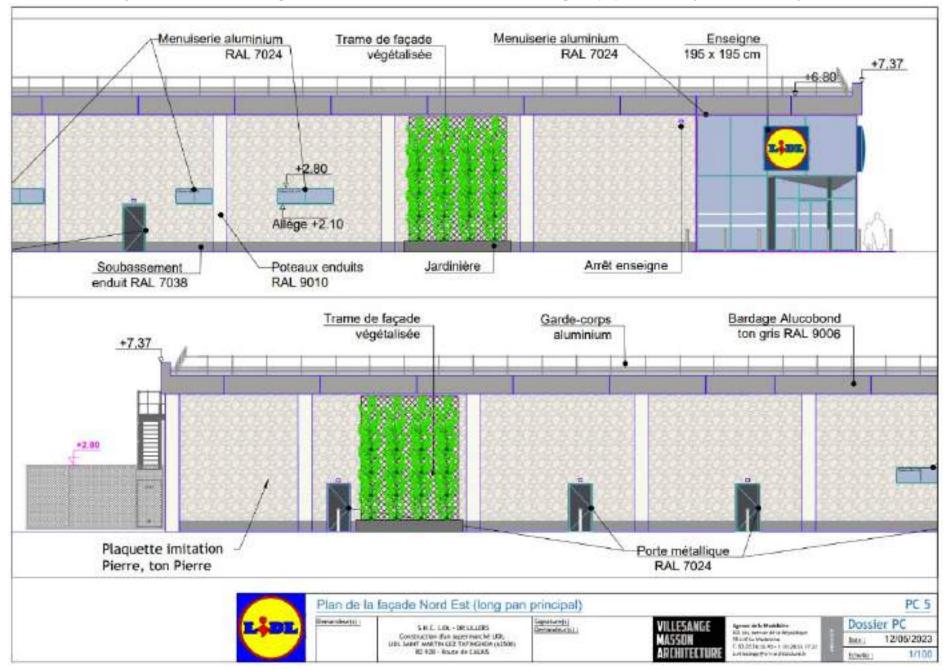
Plan de la façade nord-est ; Source : Villesange Masson Architecture
